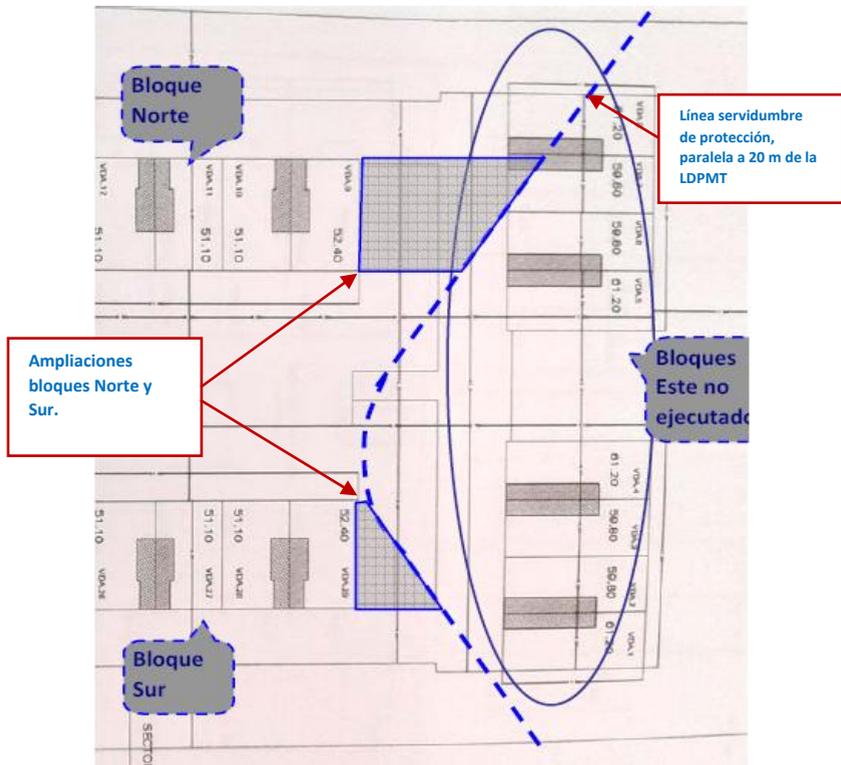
Propuesta de ampliación bloques Norte y Sur
